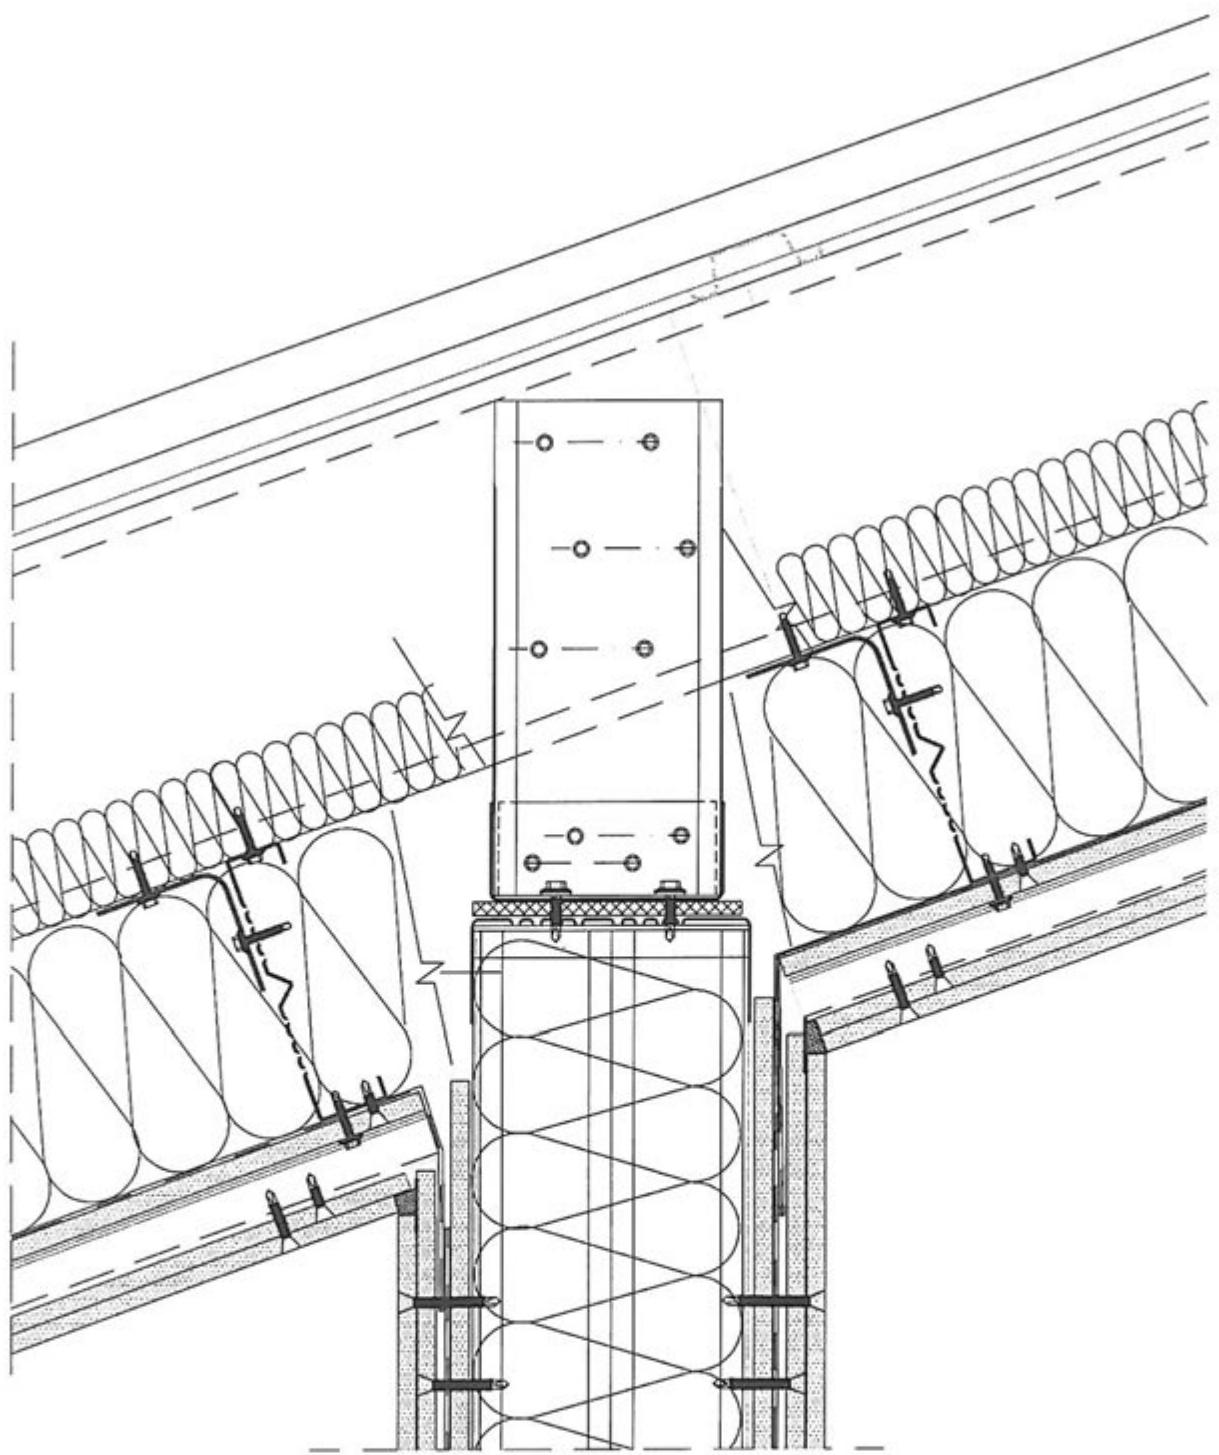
Узел крепления и примыкания конструкции чердачного перекрытия в месте опирания кровельной балки на внутреннюю несущую стеновую панель.
